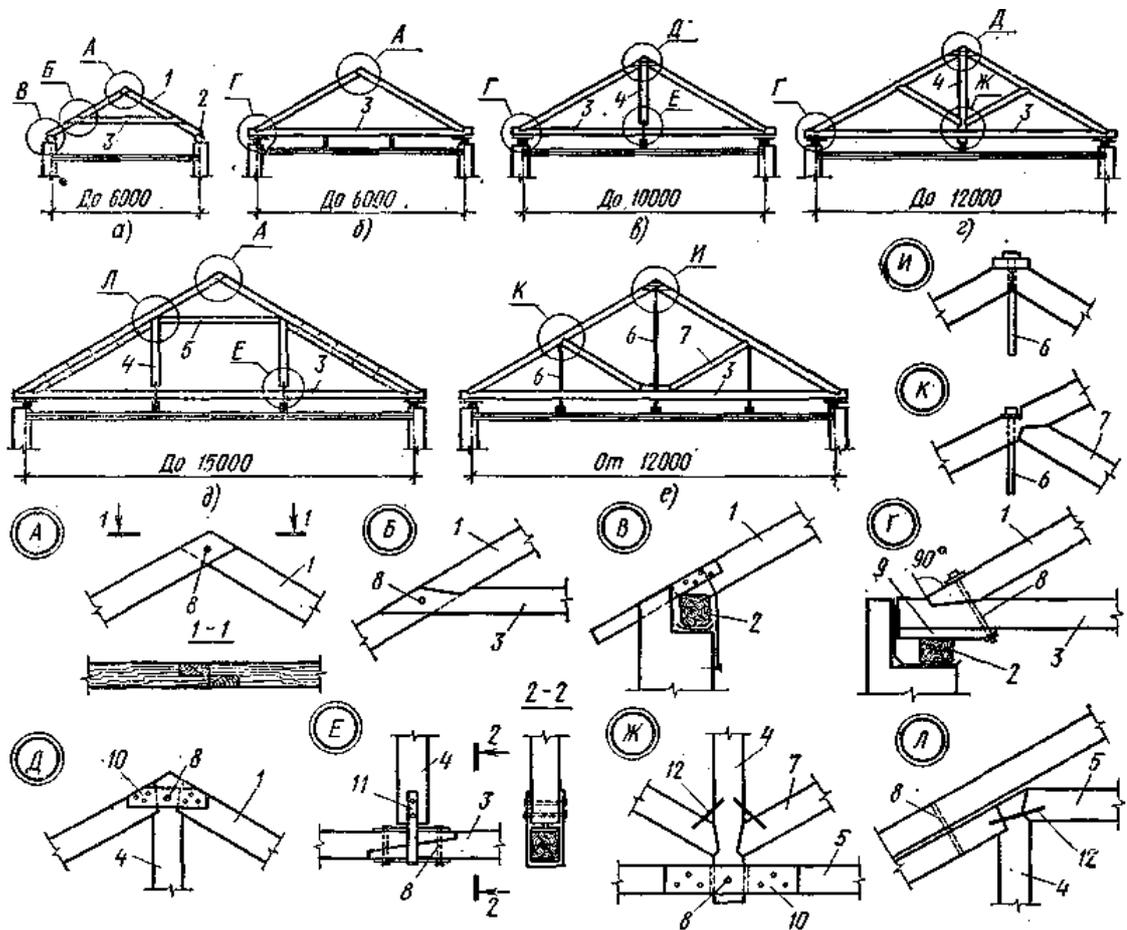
Деревянные висячие стропила (стропильные фермы):
